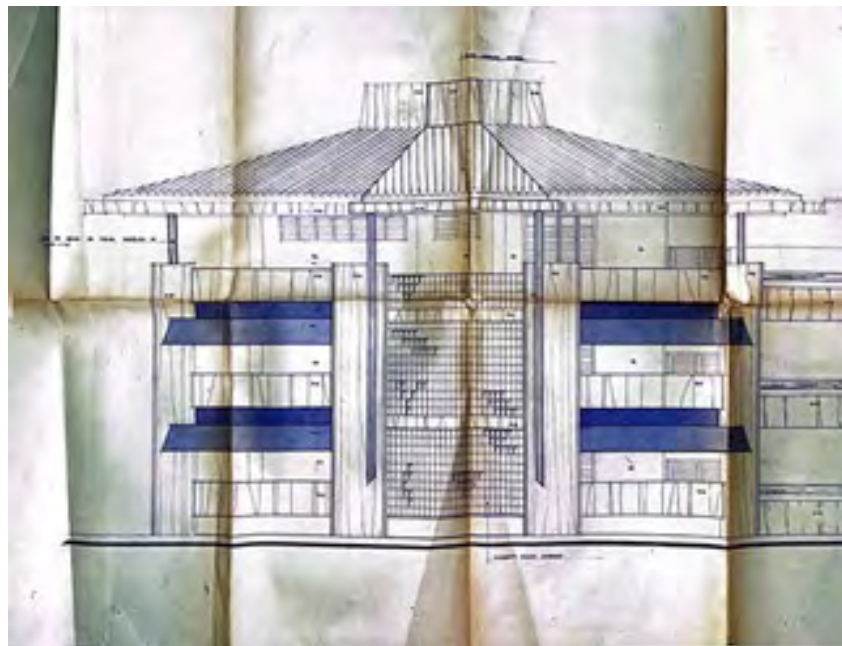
Detalhe da fachada em prancha para o projeto da Sede d SEDUC.
